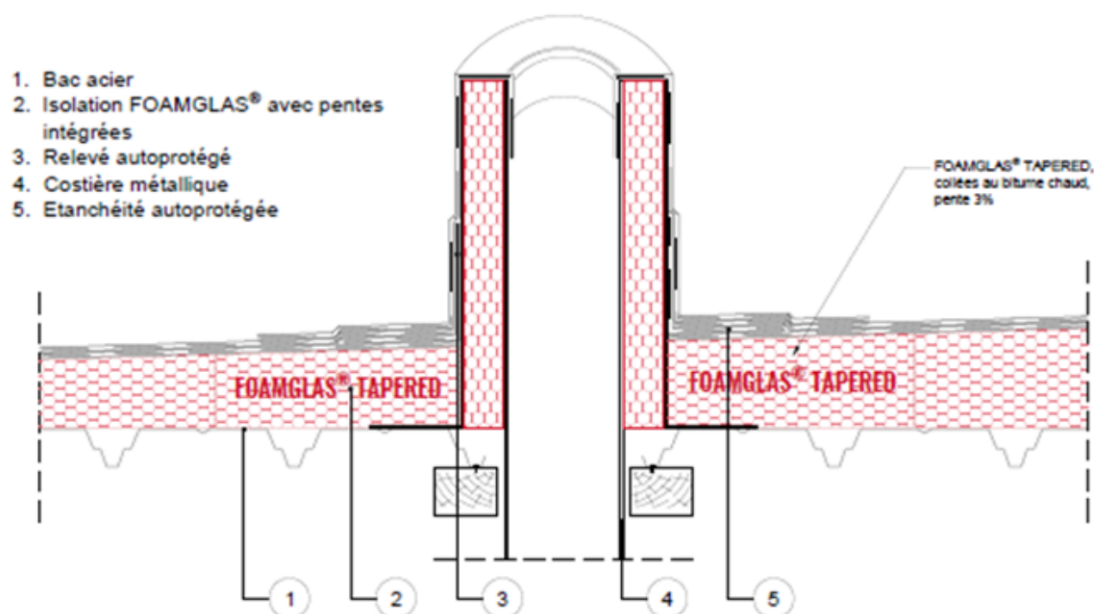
Coupe sur isolation d'un conduit de ventilation sur TAN en local TFH
